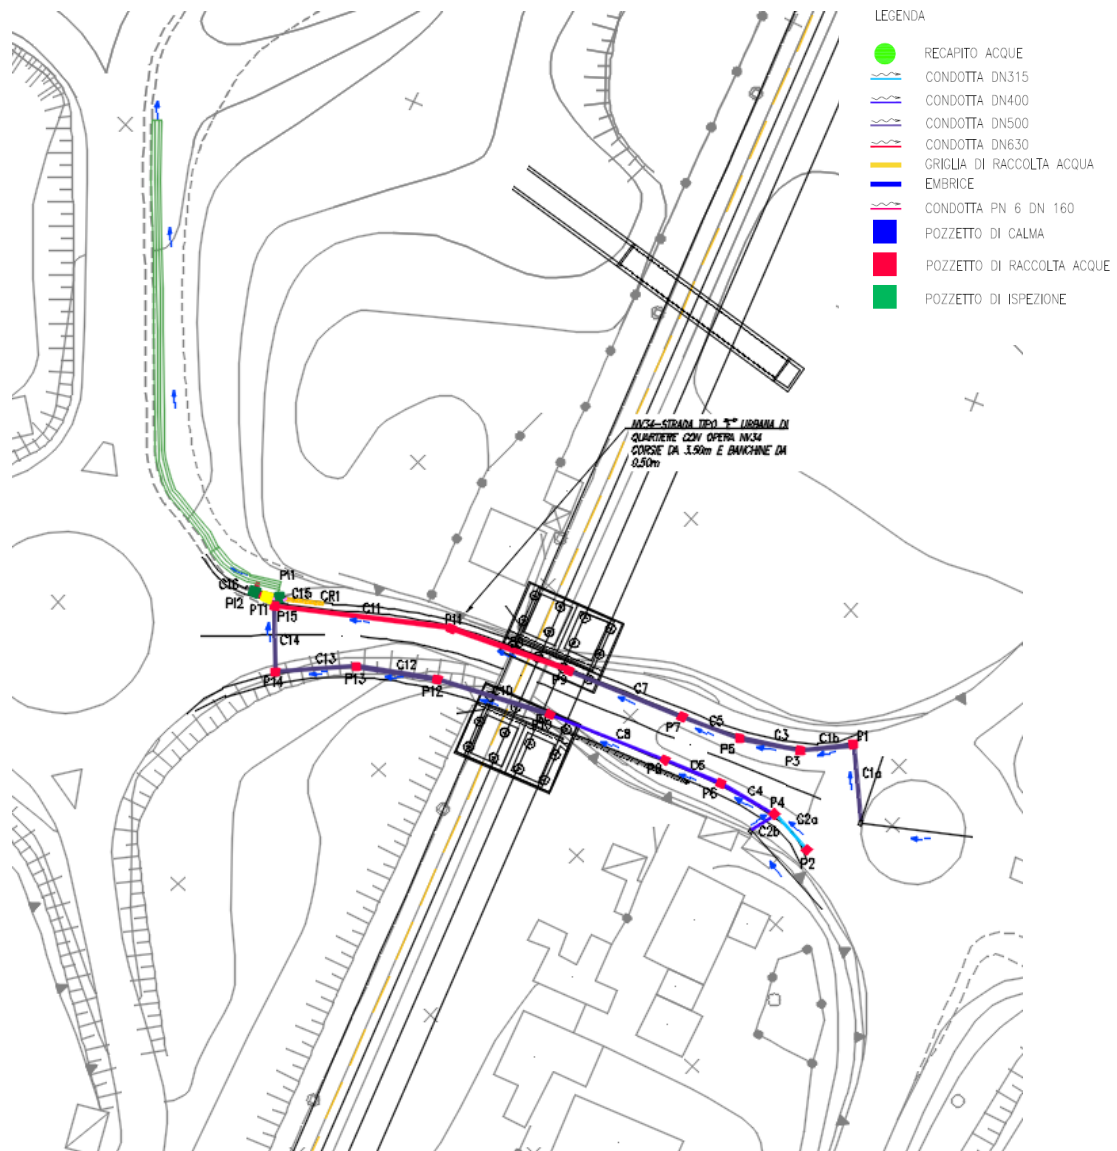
Stralcio planimetrico della rete di drenaggio Viabilità NV34
